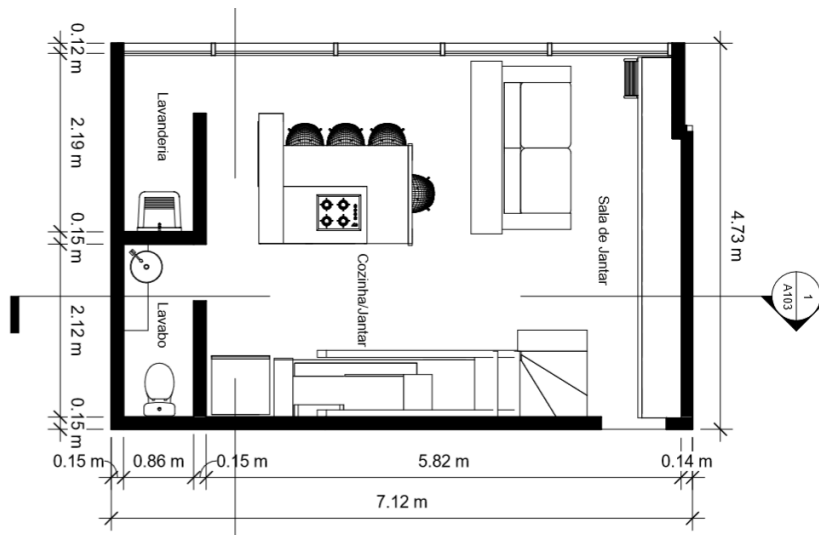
Planta baixa do pavimento inferior do *loft* duplex Metanias Seman Hallack.
